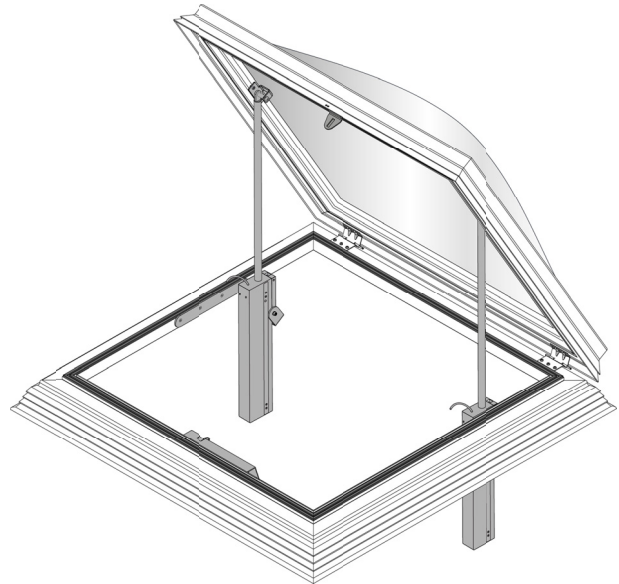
Spindelantriebe Dachausstieg Typ M \geq 125 cm
